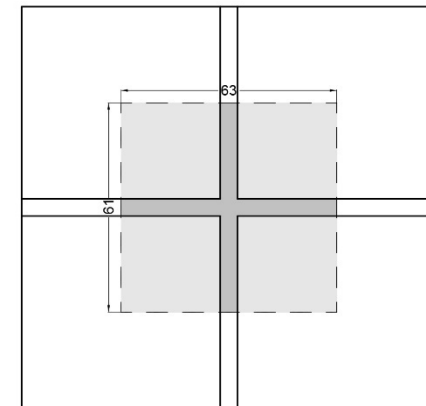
Planta losa aligerada, ámbito para el cálculo de la densidad equivalente
